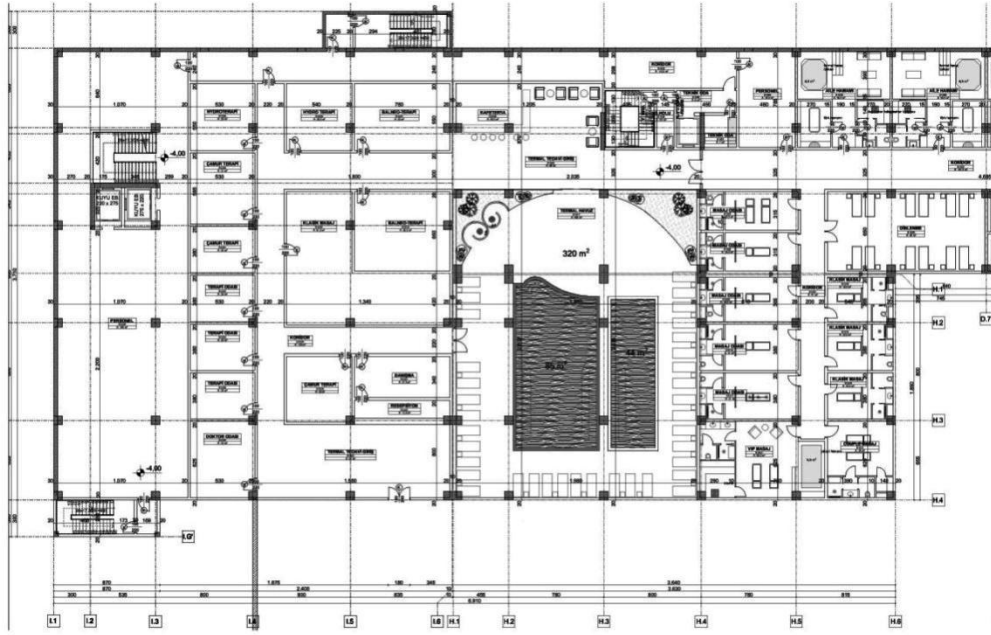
Mercan Spa Kat Planı.¹⁰⁰
